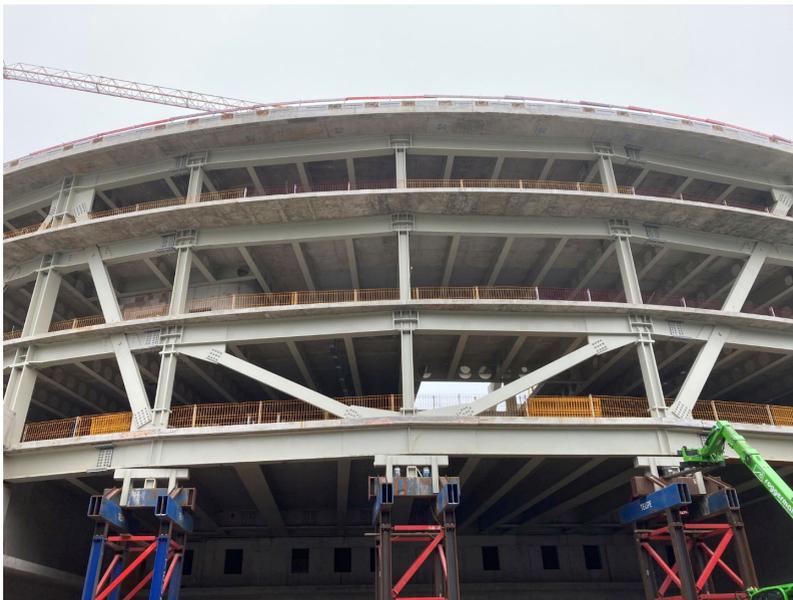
gekrümmter Fachwerkträger kurz vor dem kontrollierten Ablassen
